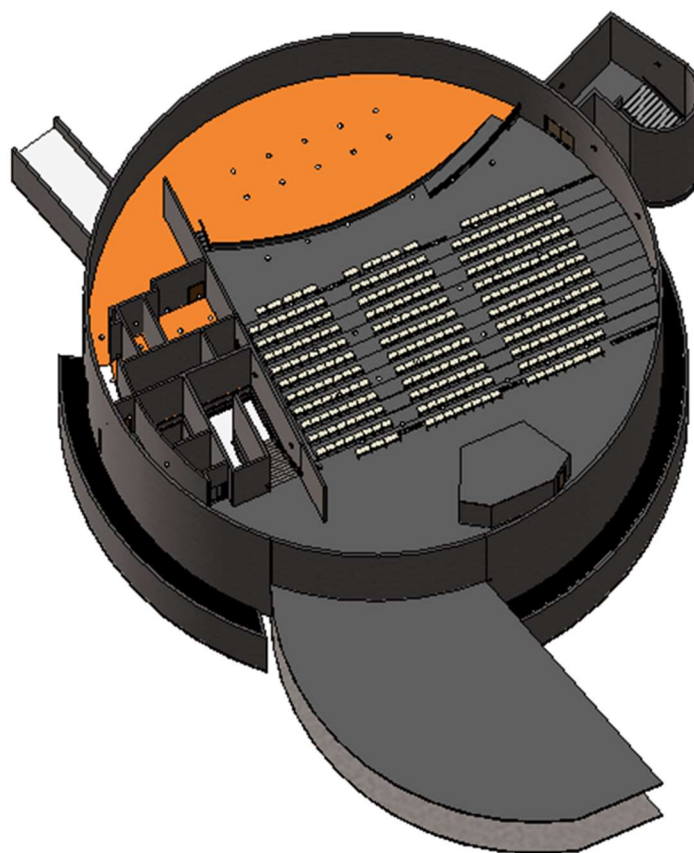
Perspectiva do Bloco do auditório – Primeiro pavimento
